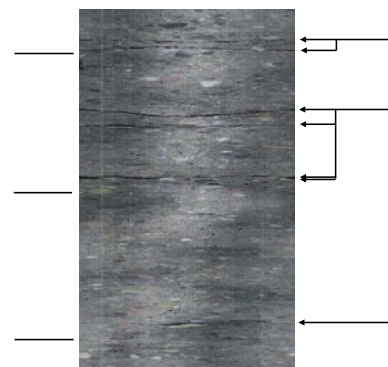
ボアホールカメラでとらえた場所打ち杭のひび割れの様子 (A2橋台)
